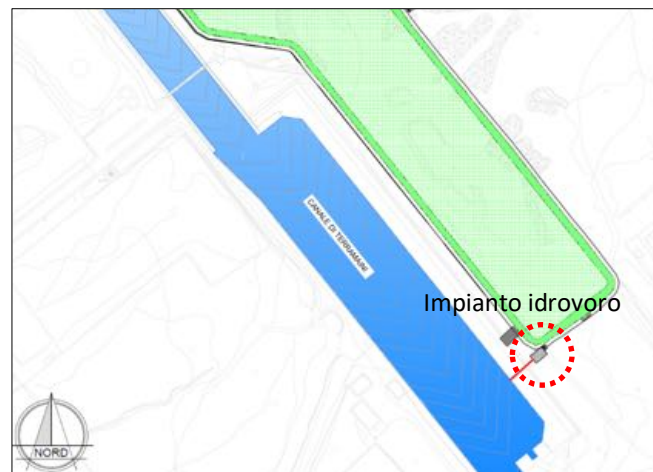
Planimetria dell'invaso n.2 e ubicazione dell'impianto idrovoro.
